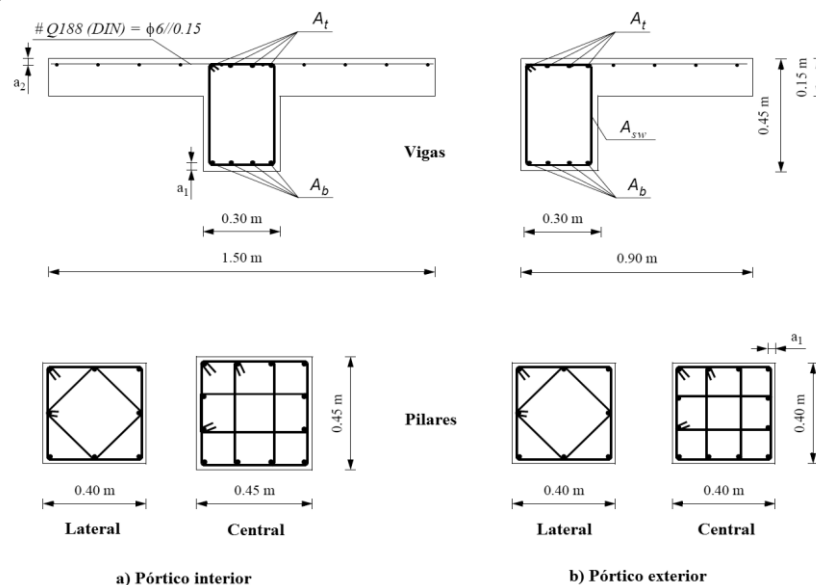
Secções transversais das vigas e das colunas para o pórtico interior e exterior (adaptado de Arêde (1997)).
